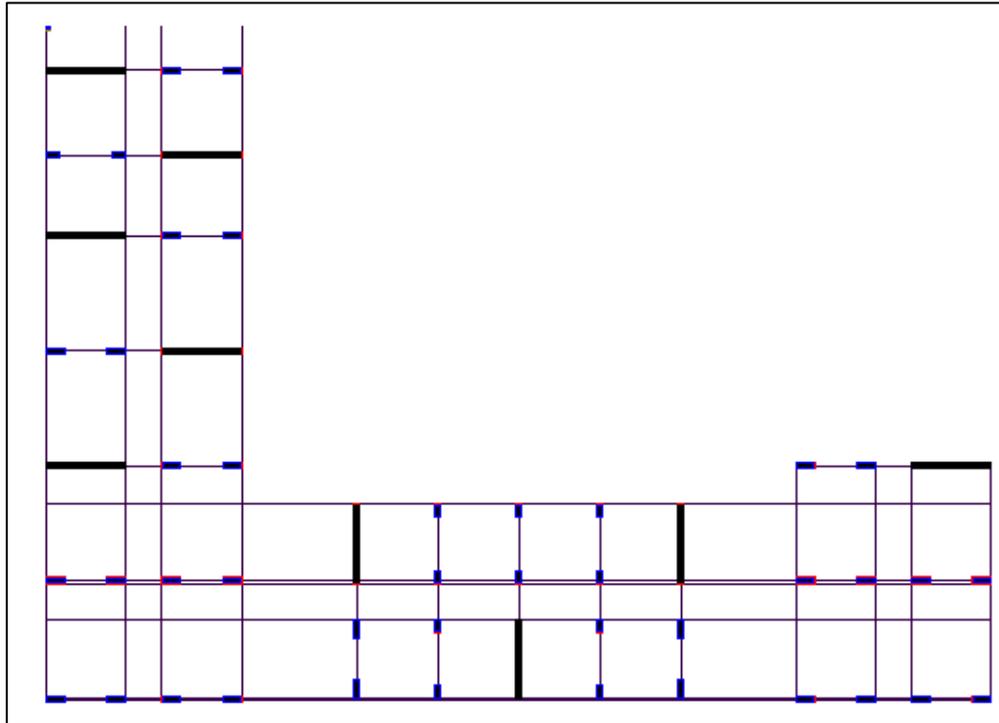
Denah Kolom dan Dinding Geser Bagian Luar Lantai 14 Sampai Lantai Atap Tipe C
